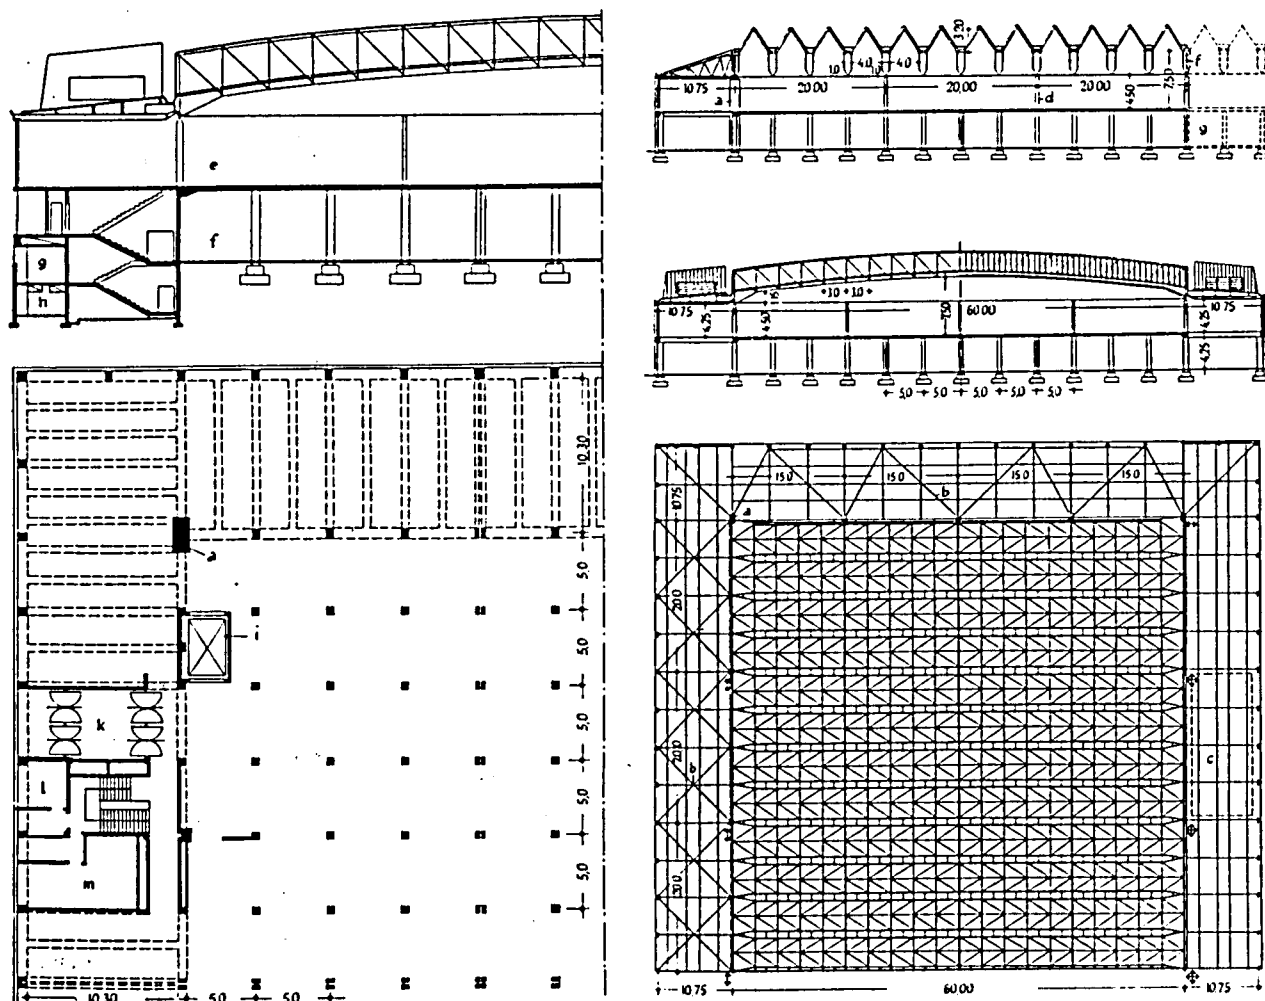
Desenho de uma parte da planta do piso inferior e de um corte transversal à escala 1/500, bem como um corte longitudinal, um corte transversal e a planta da cobertura à escala 1/1000, da fábrica de maquinaria Friedrich Deckel
